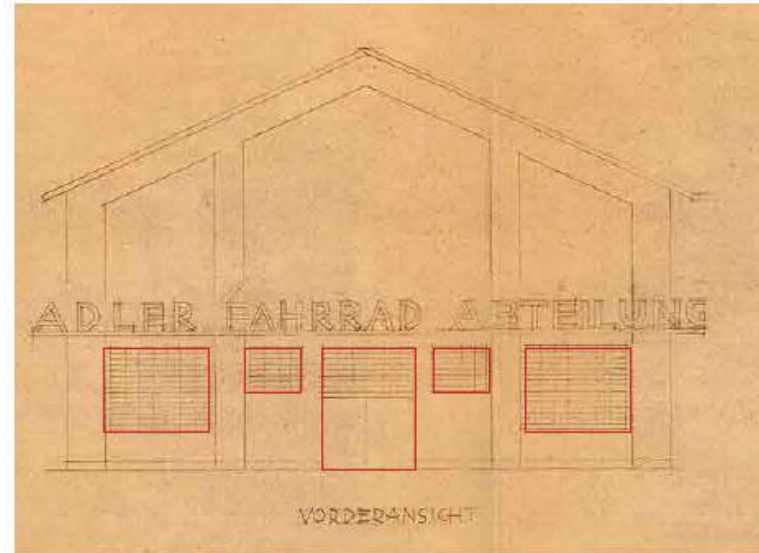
Entwurf von 1927. Ansicht West. Fensteröffnungen im EG, Vordach mit Werbeträger an der Fassade (Bd. 05/020)
